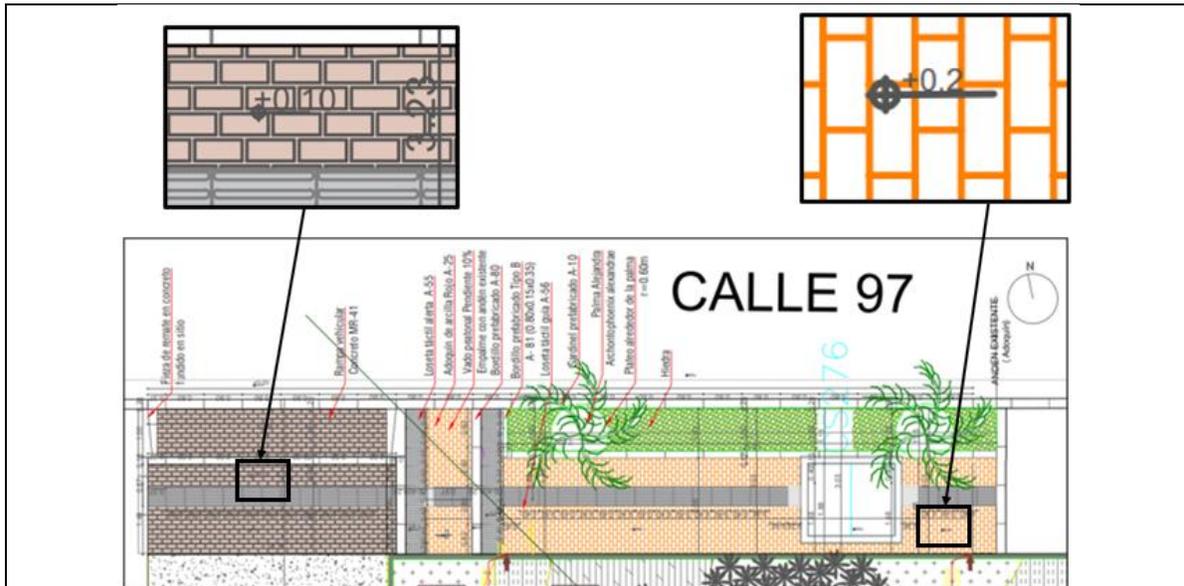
Planta de diseño Calle 97 indicando el área de detalle que precisa el nivel
